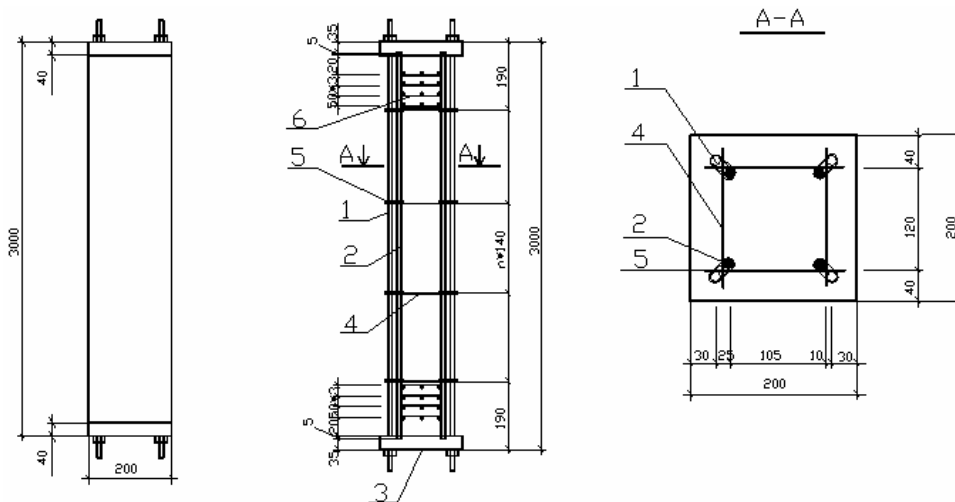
Арматура колон: 1 – попередньо розтягнена арматура класу А-II Ø20; 2 – попередньо стиснута арматура класу Ат-V Ø18; 3 – опорна металева плита; 4 – поперечна арматура; 5 – спеціальні фіксатори; 6 – сітки
